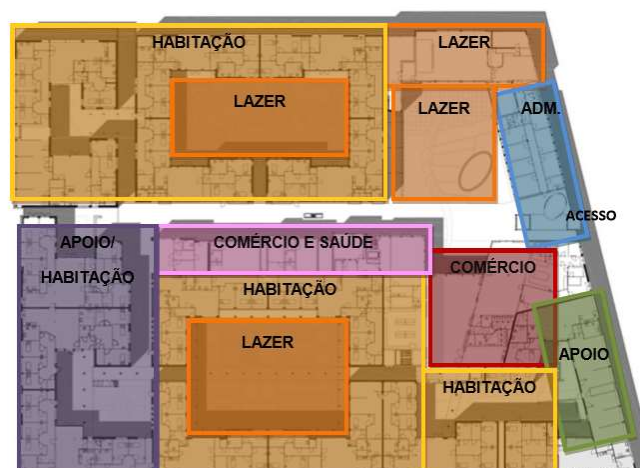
Planta baixa com setorização da Vila de Hogeweyk
